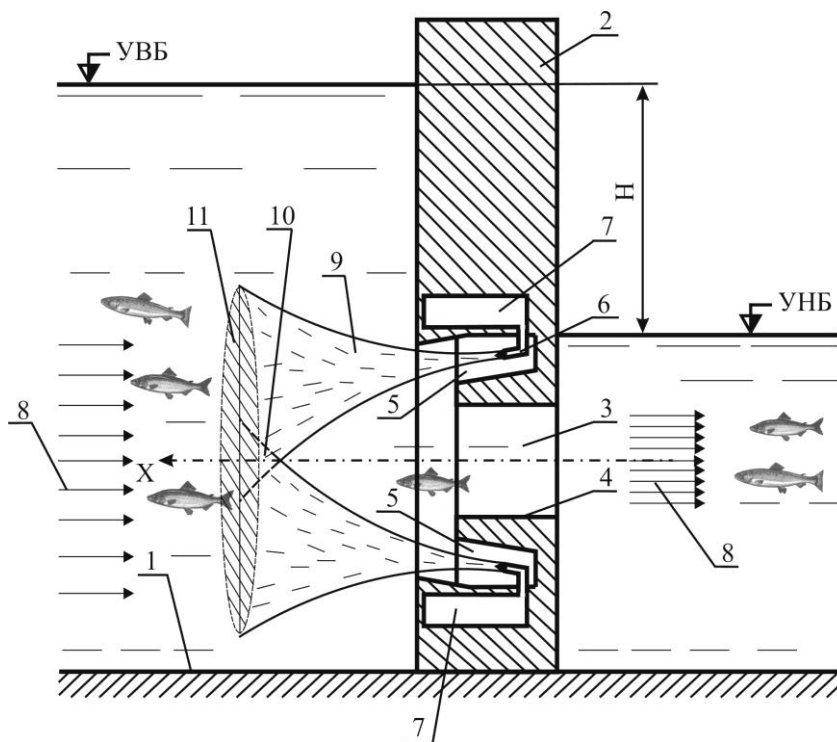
Схема конструкции вливного отверстия с глухой галереей, продольный разрез:
